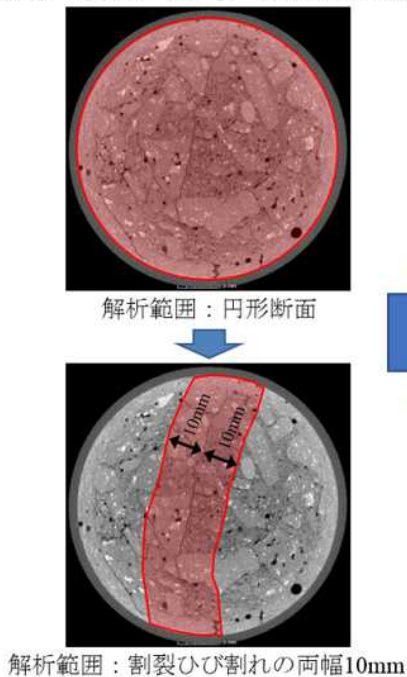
解析範囲を割裂ひび割れ付近とした例
